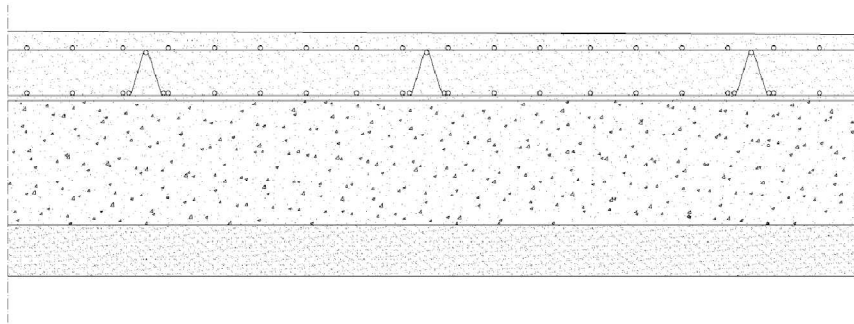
Piso de betão com armaduras superior e inferior (adaptada de [66])
